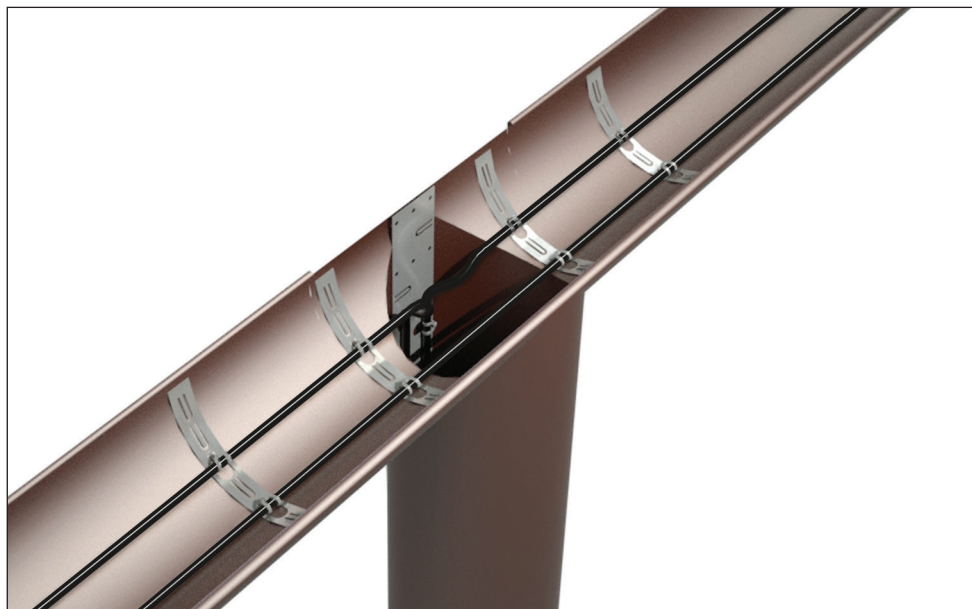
Монтаж кабеля в водосточном желобе и вертикальной трубе
